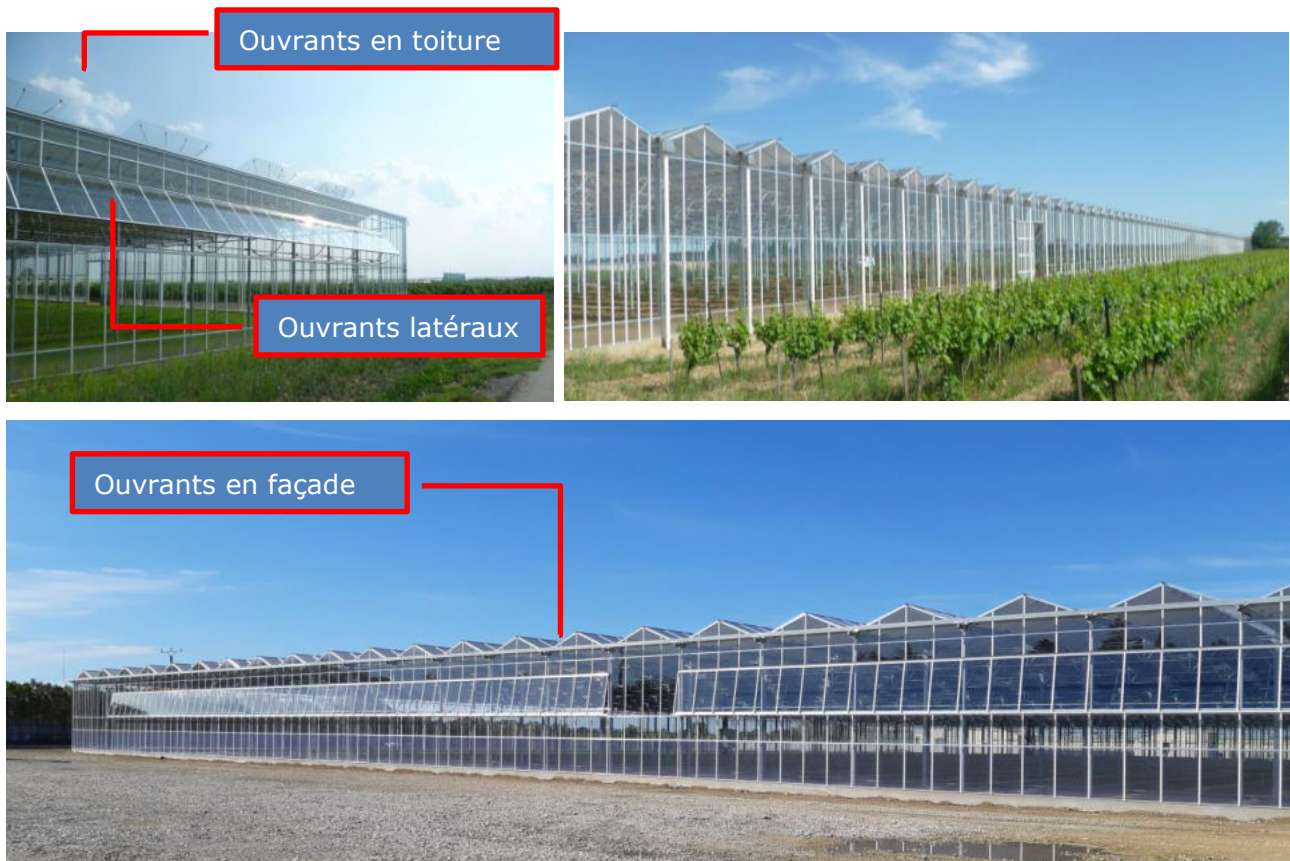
Ouvrants en façade et en toiture. Source : Reden.
